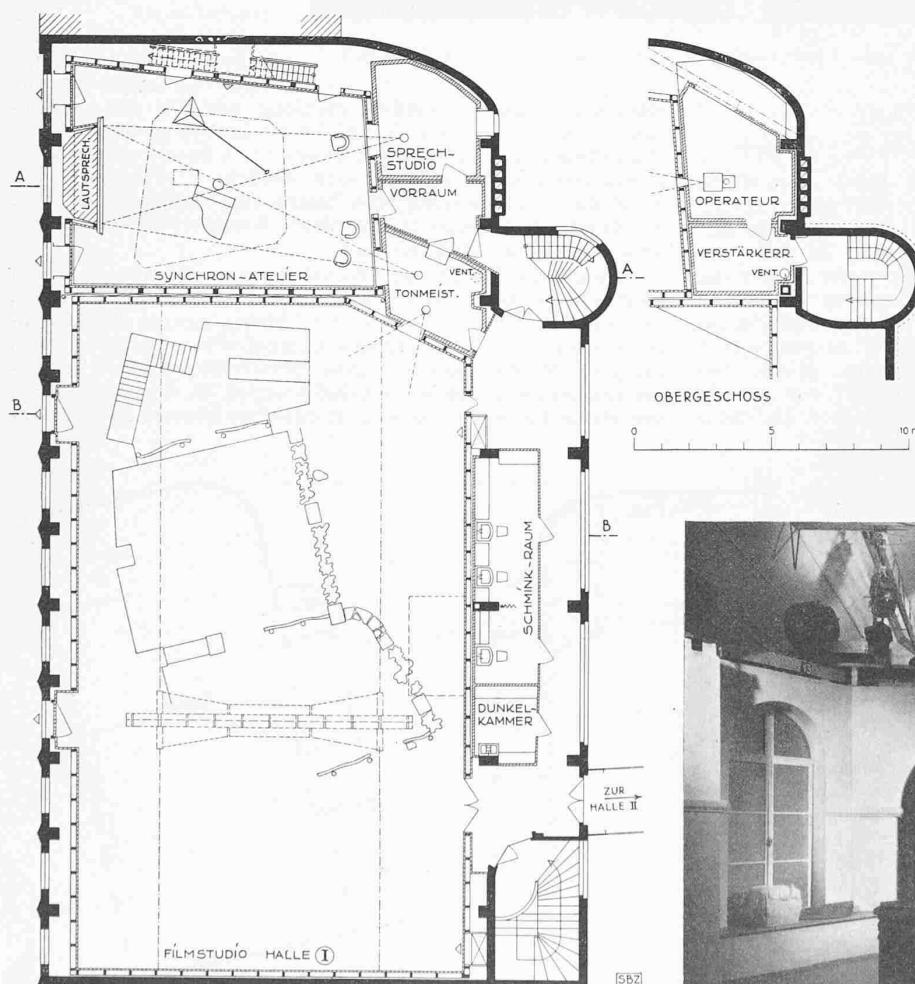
Grundrisse der Halle I und des Synchronateliers
